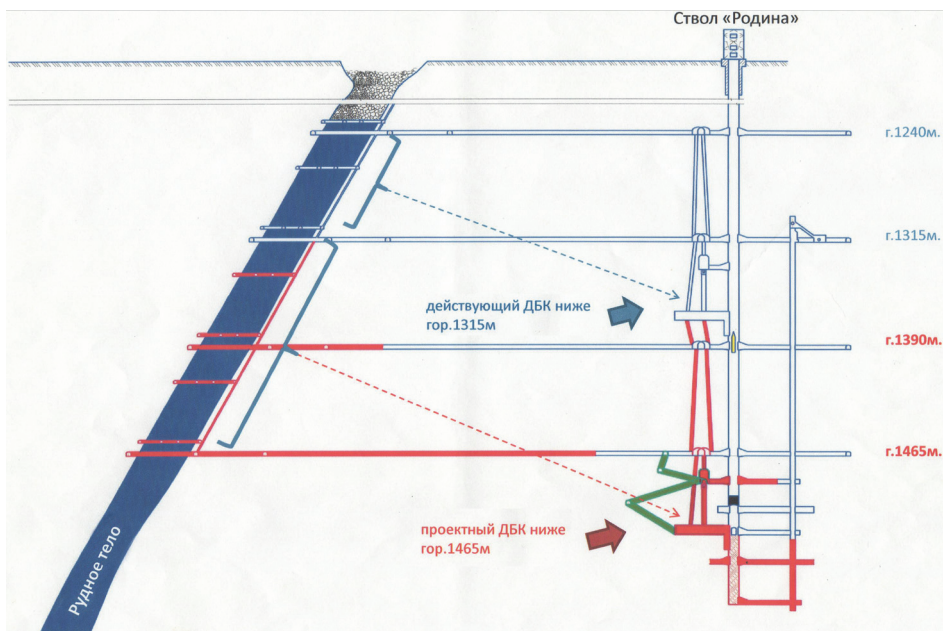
Принципова схема розкриття та підготовки родовища шахти «Родина» здвоєними поверхами: 1 – капітальні рудоспуски; 2 – дробильно-бункерний комплекс; 3 – дозатор
